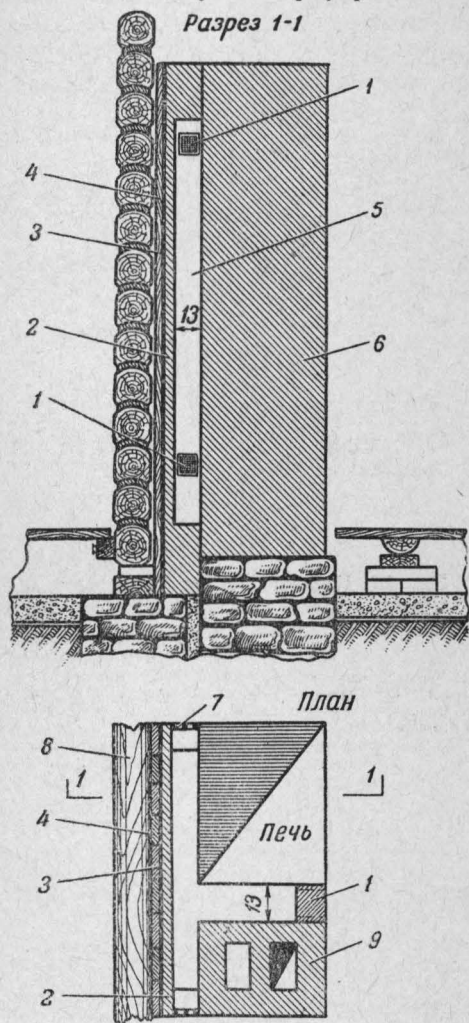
Установка печи периодического действия у деревянной рубленой стены с закрытой отступкой и устройством внизу и вверху решеток для циркуляции воздуха:
